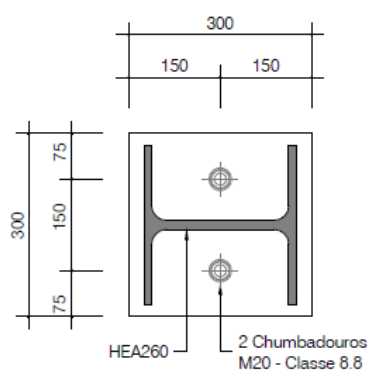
Pormenor em planta da ligação a verificar, associada ao método I. [SE2P]
